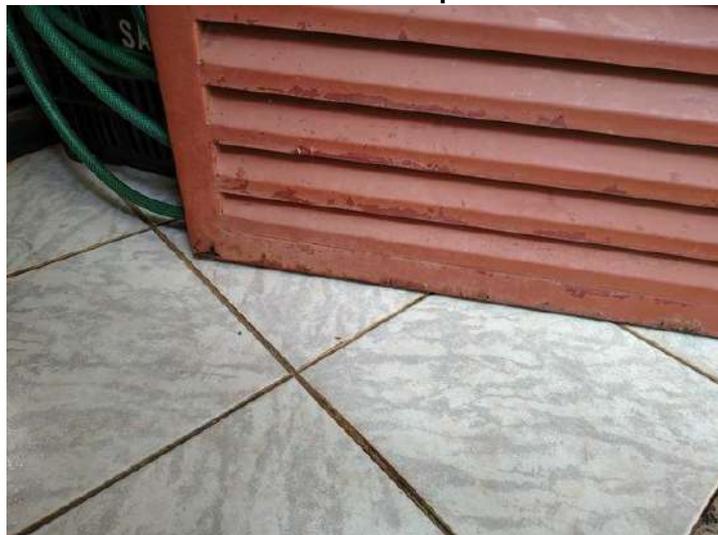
Lavanderia - Oxidação e deterioração da pintura da porta de entrada
